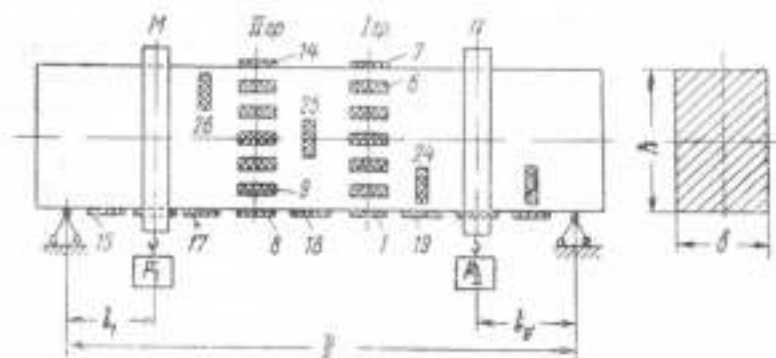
Схема лабораторной установки для испытания на изгиб прямоугольной балки
